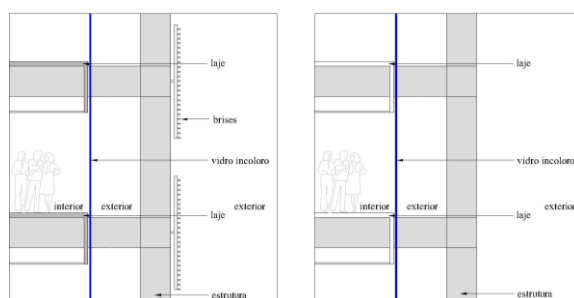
Corte da fachada do projeto original com e sem brises. Fonte: elaborado pelos autores.
